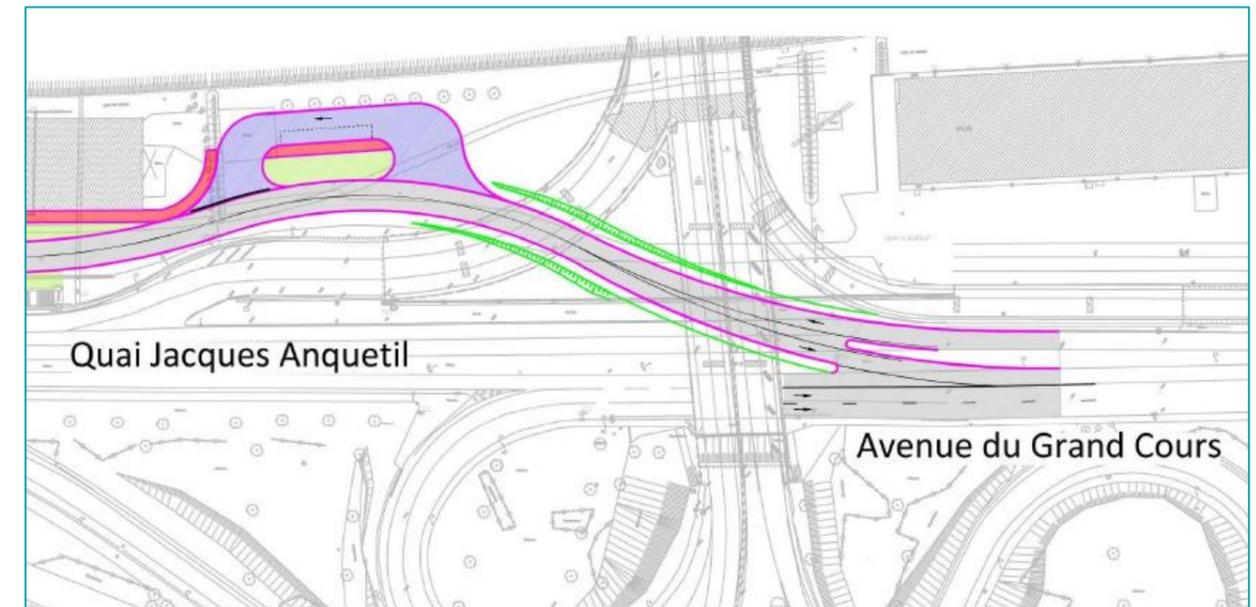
Plan du raccordement de la nouvelle voirie sur l'avenue du Grand Cours
